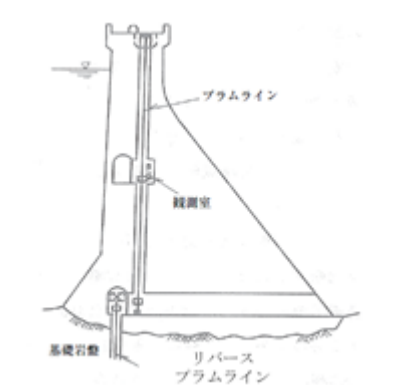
重力式コンクリートダムに設置されたプライムライン
